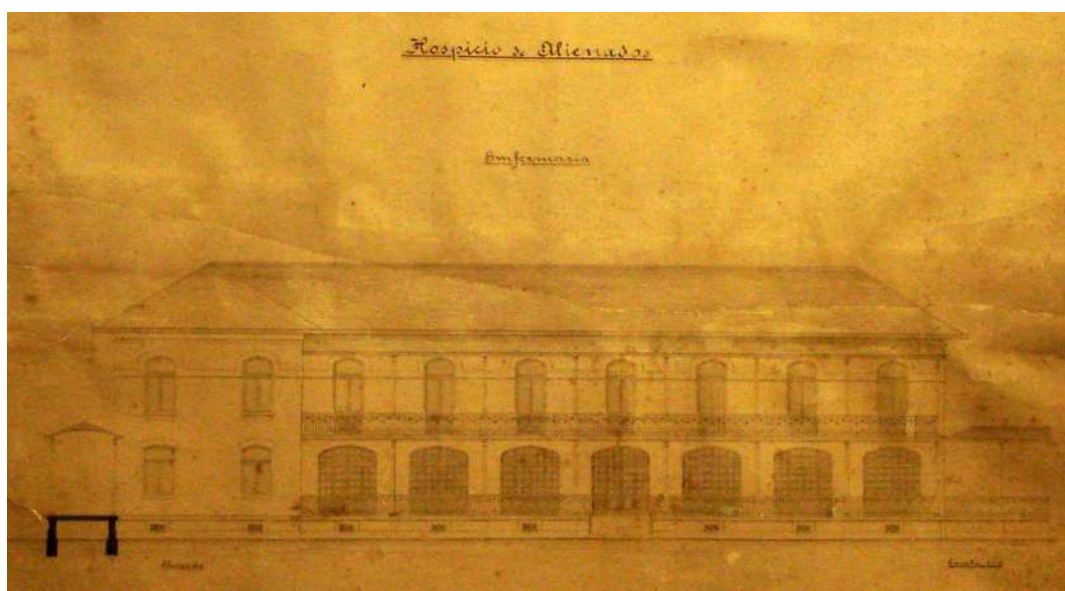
Fachada lateral do pavilhão de enfermaria (acervo do Museu Osório César);
